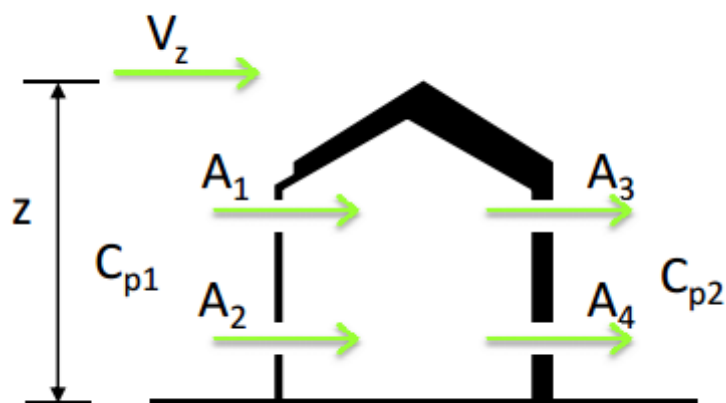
Ventilação cruzada devido à ação do vento, com duas aberturas por fachada. (Adaptado de Lamberts, 2009)
